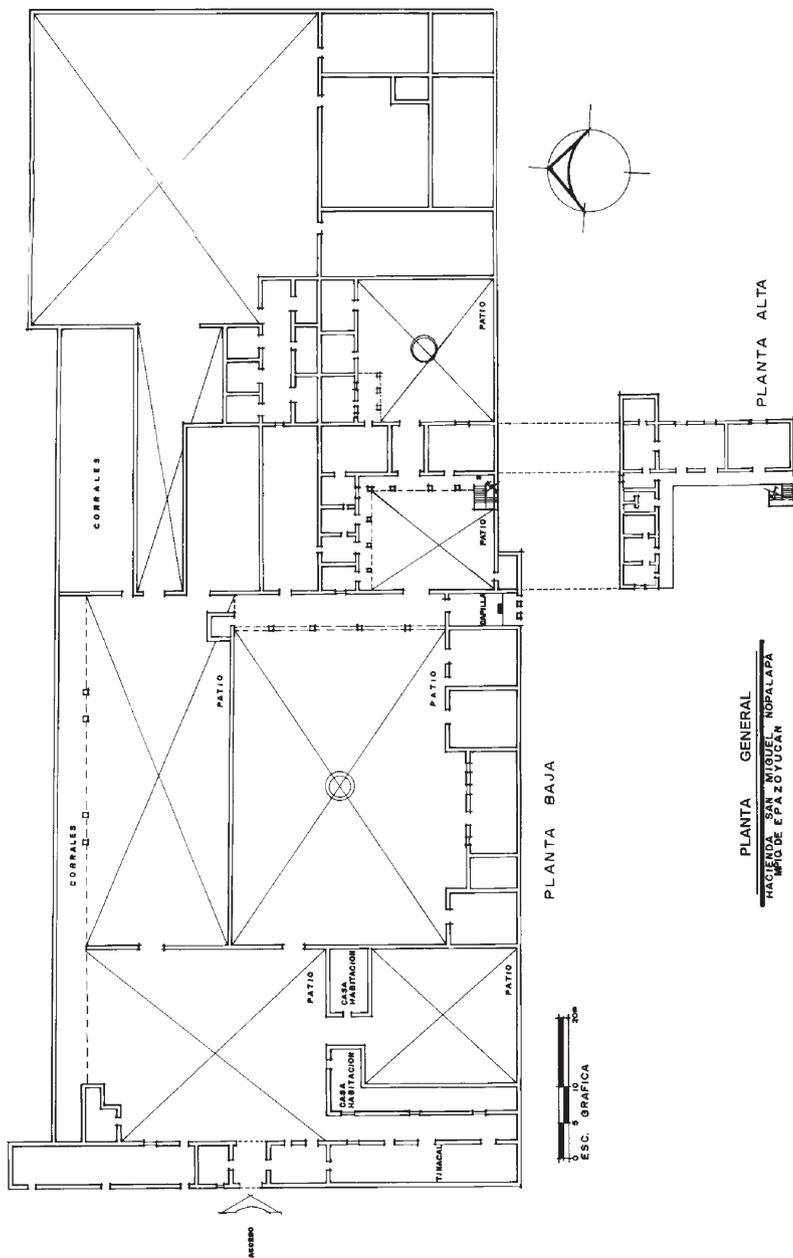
Hacienda de San Miguel Nopalapa. Planta general.
